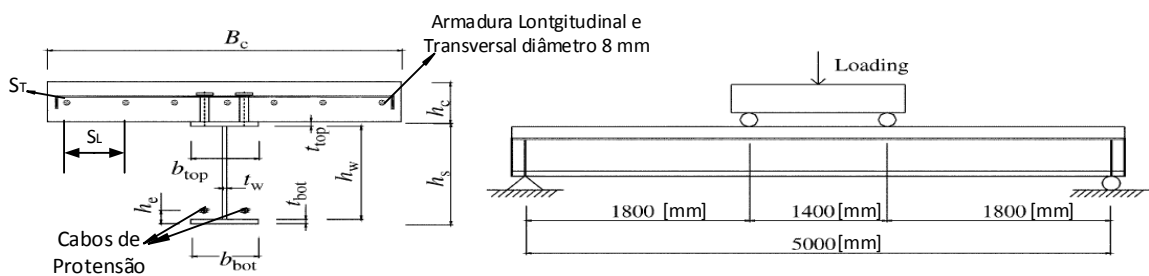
Geometria das vigas modeladas. (CHEN e GU, 2005) Adaptado pelo autor
